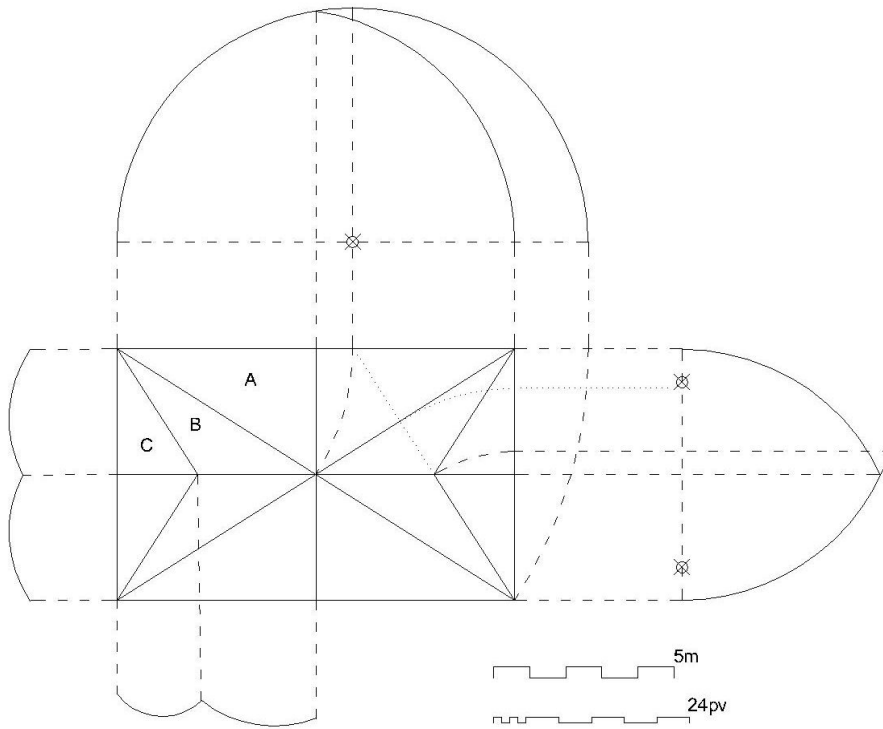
Trazados de planta y aristas de un tramo de la capilla.
